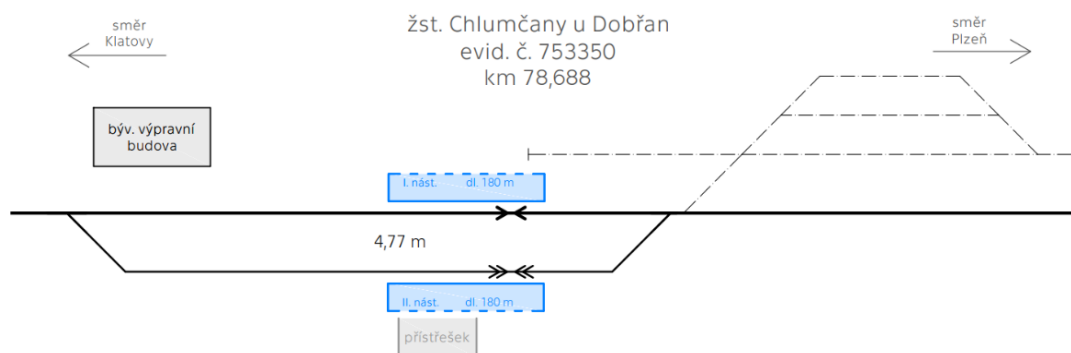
Dopravní schéma žst. Chlumčany u Dobřan – varianta A
